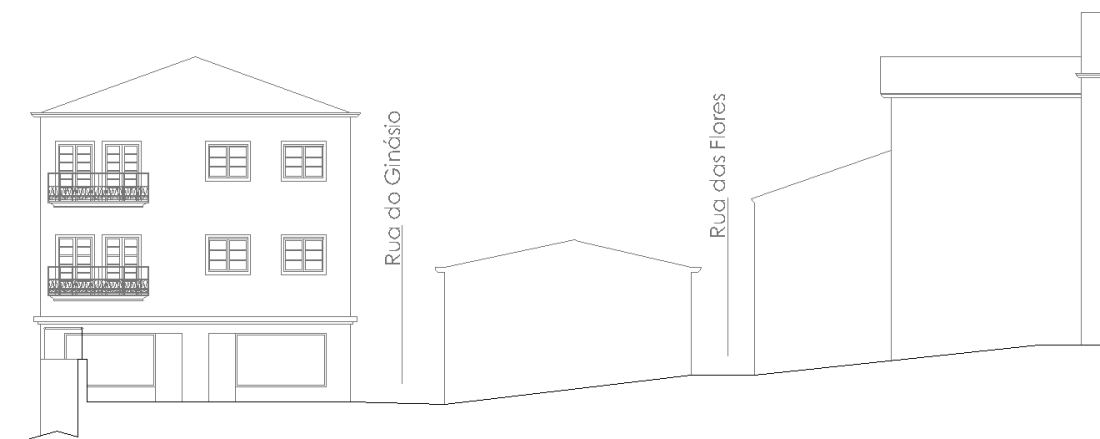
Levantamento das fachadas poente da transversal Rua do Ginásio-Rua das Flores. Ver Anexo 9.
